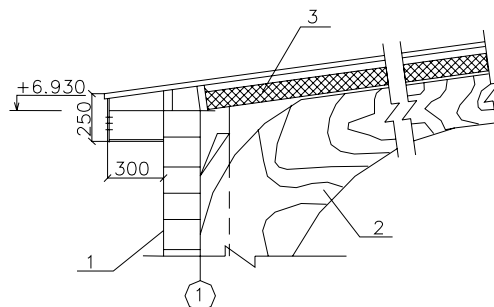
Карнизний вузол: 1 – стінова огорожа, 2 – вигнуто клеєна дерев'яна рама, 3 - плита покриття на дерев'яному каркасі
